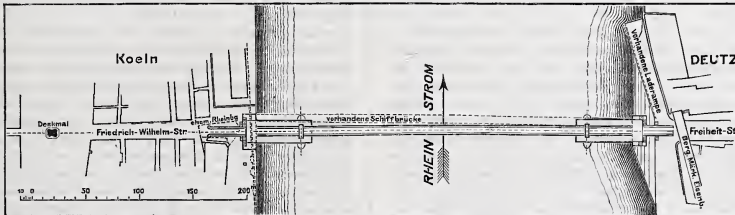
Lageplan für die Rheinbrücke zwischen Köln und Deutz.
